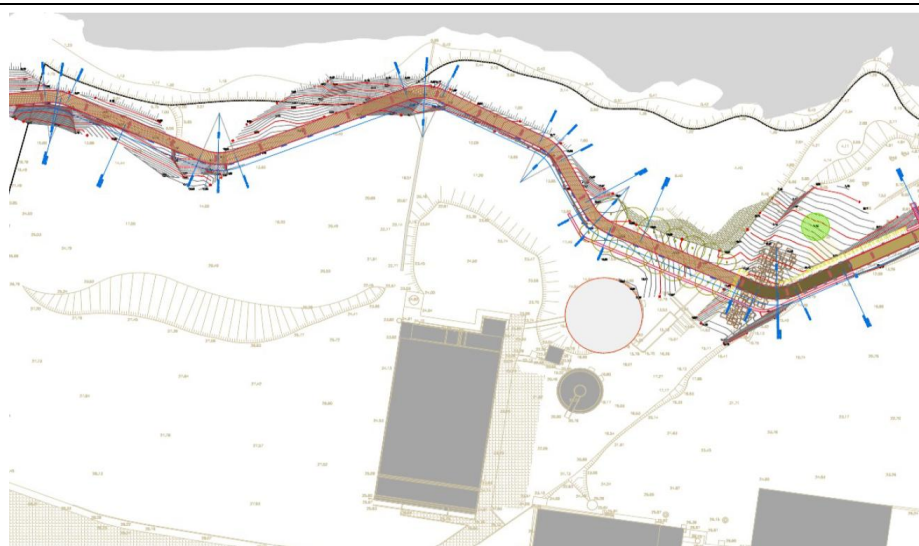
Planta de implantação da Ecovia a construir pelo Município de Barcelos
